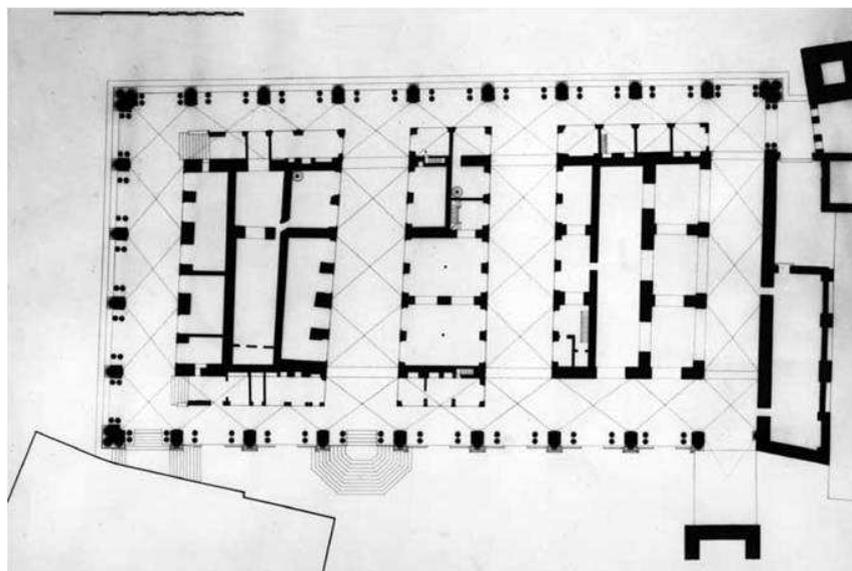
16.8 Basílica Palladiana, en Vicenza. Andrea Palladio, 1549. Planta inferior. <sup>608</sup>
